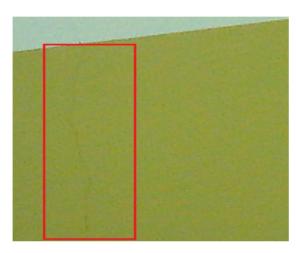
Fisura en tabique de cierre perimetral - Cuarto Nivel
